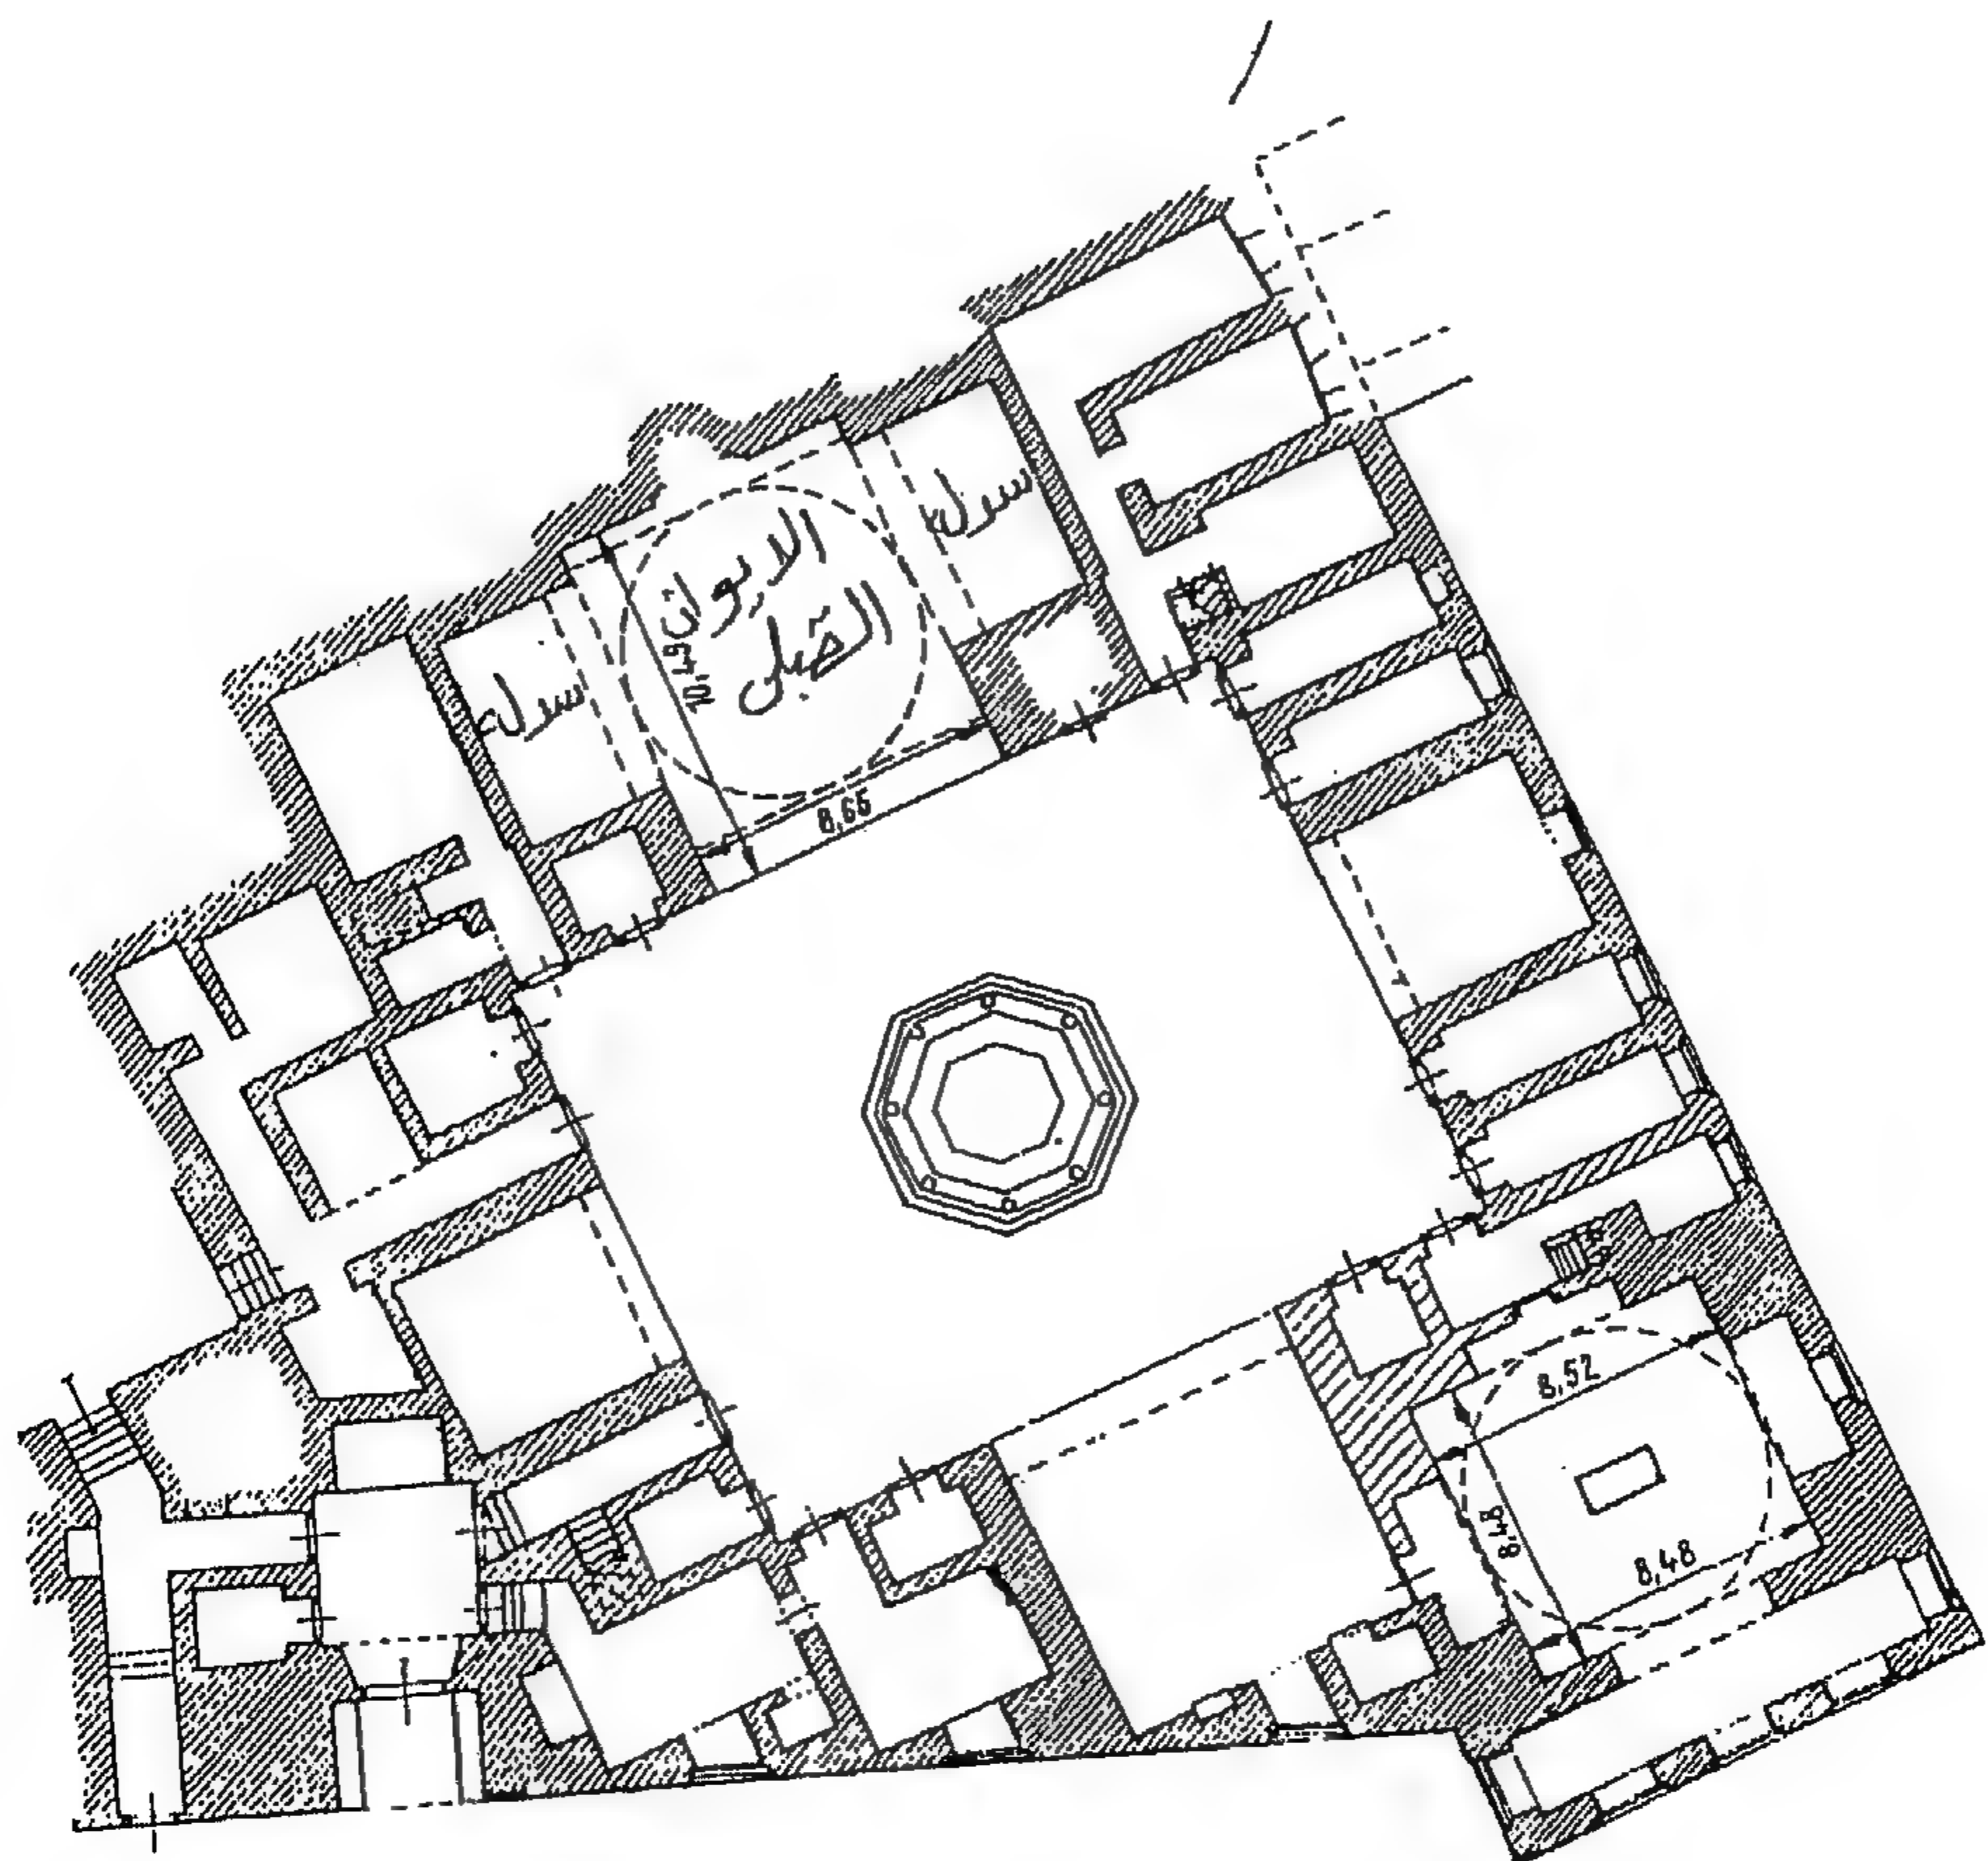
مسقط أفقي لمدرسة تتر الحجازية
